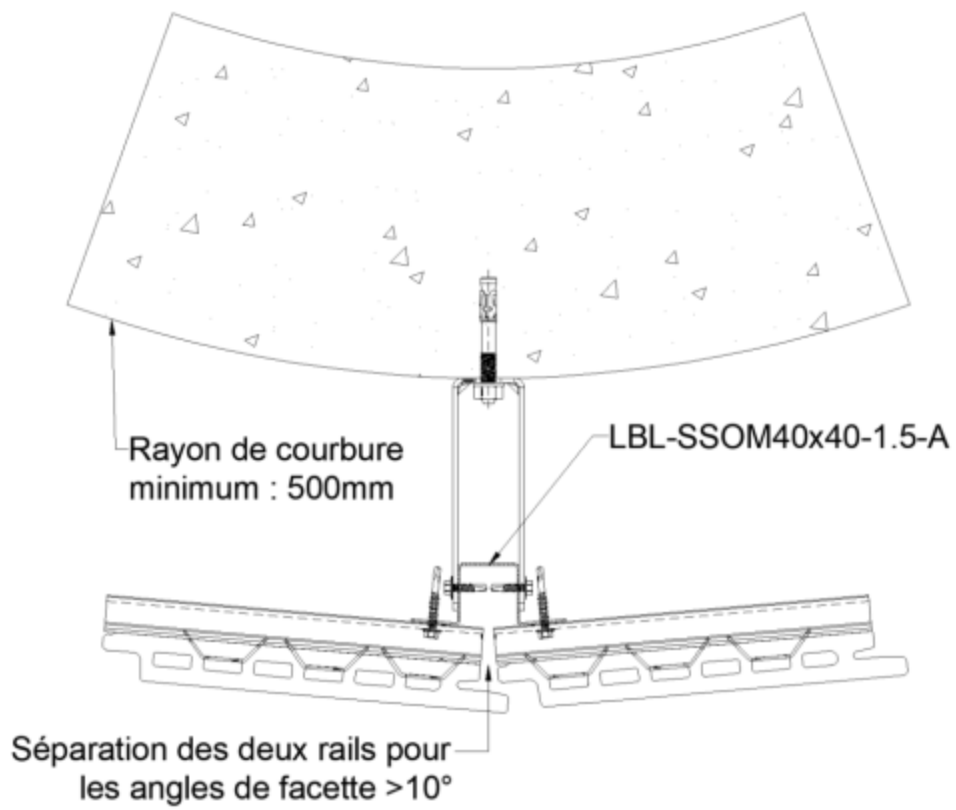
Pose à facette Terraclip® avec profil LBL-SSOM40x40-1.5-A
